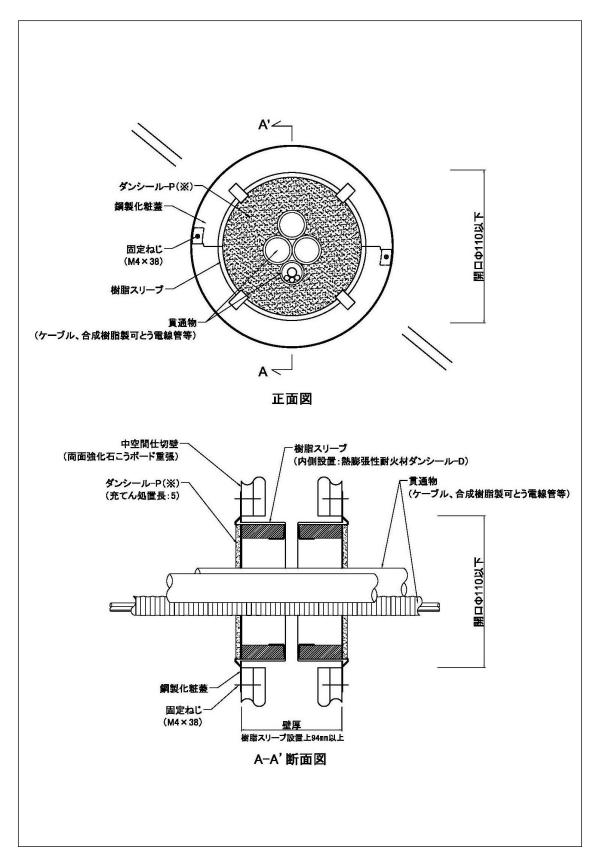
プチロクワイド 標準施工図(中空壁 両側施工)
